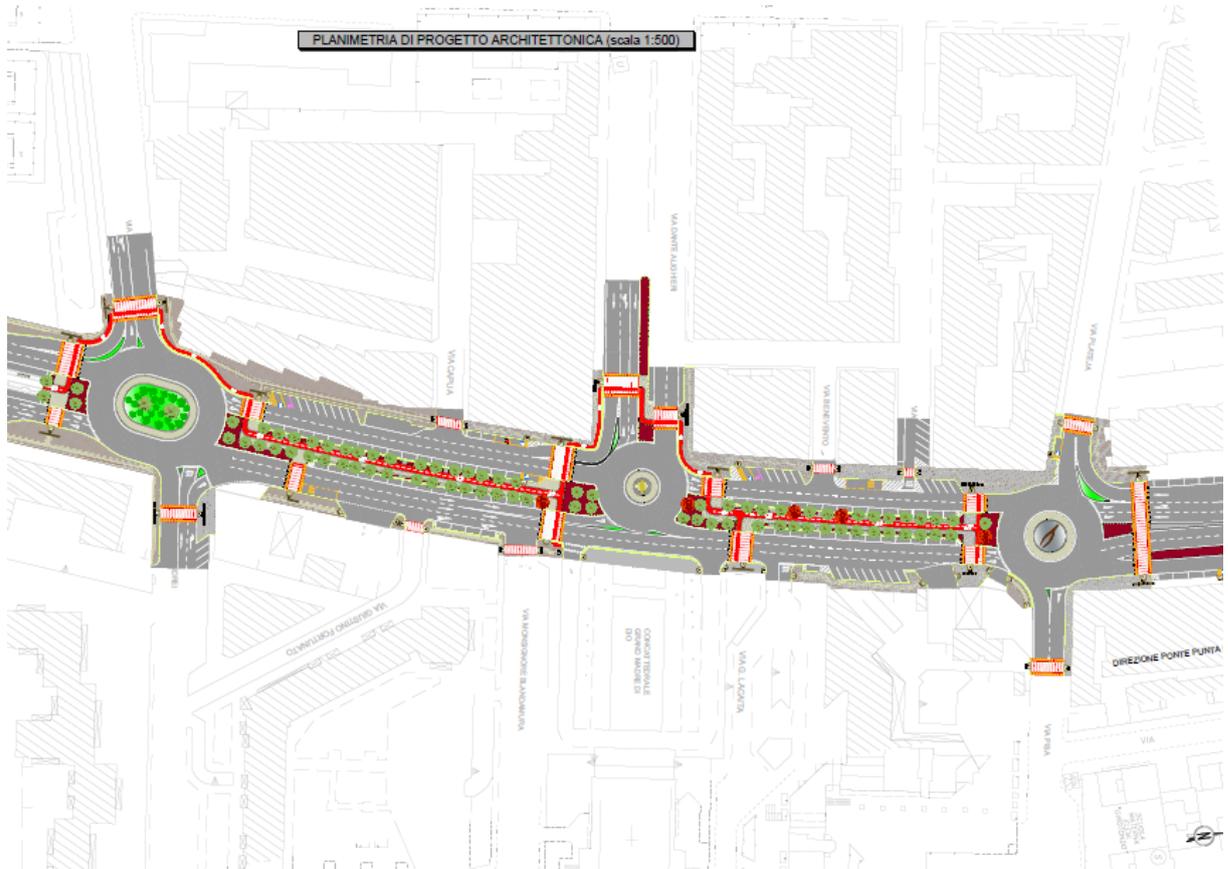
Planimetria di progetto architettonica - stralcio tavola
